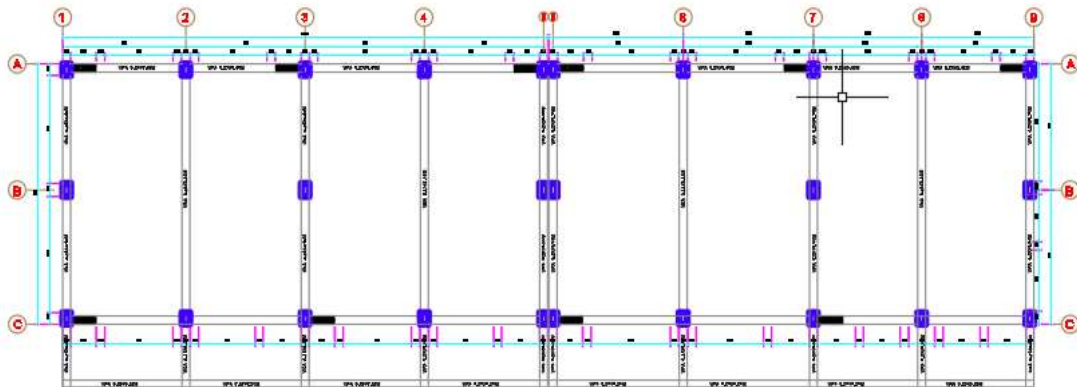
Ubicación de los muros de corte propuestos para rigidizar la estructura
